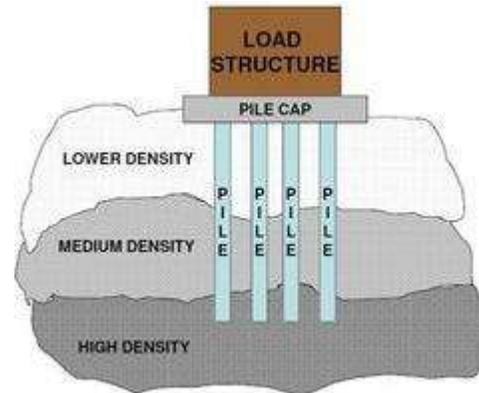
Esquema de cimentación en losa pilotada. Google imágenes.
